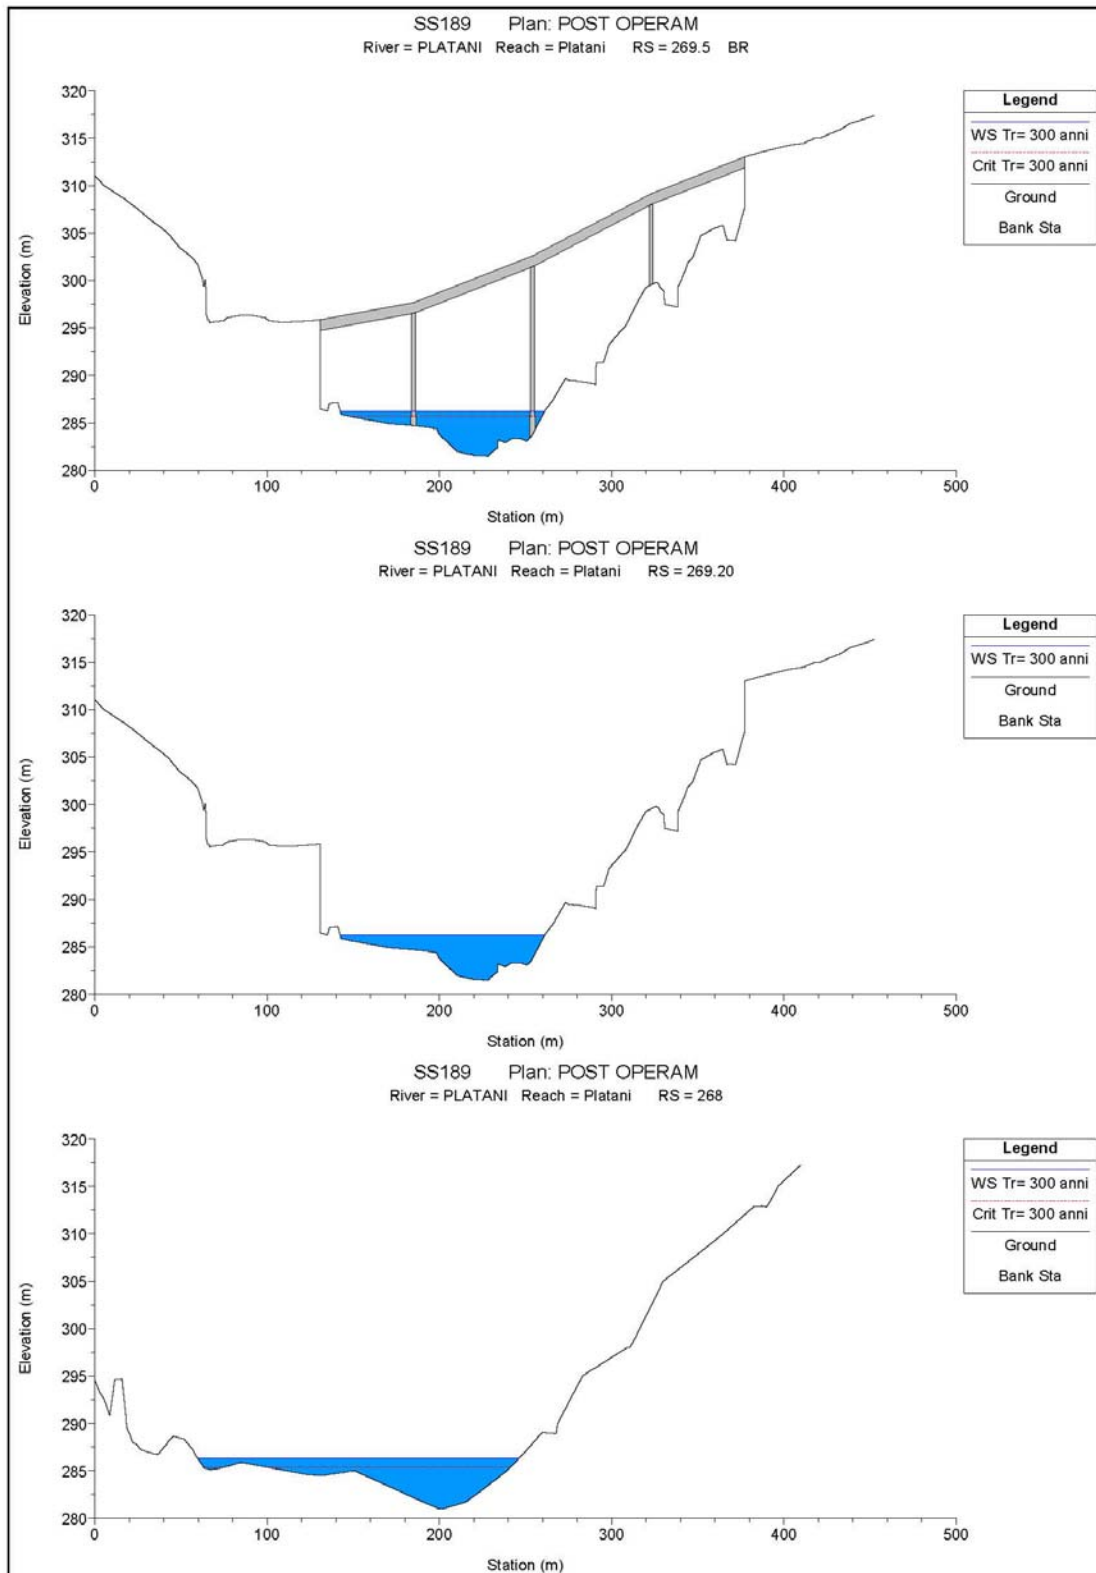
Fiume Platani: Sezioni P.O. interessate dalle opere di sistemazione idraulica
